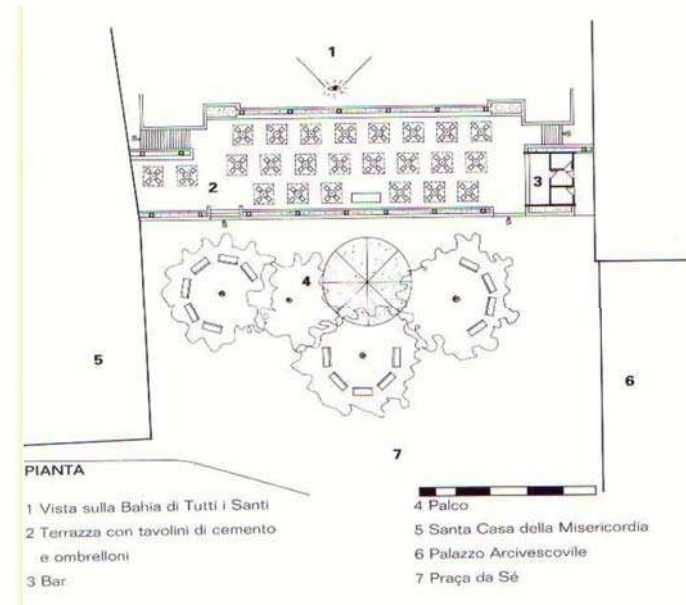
(ao lado) – Planta de intervenção no Belvedere da Sé.
